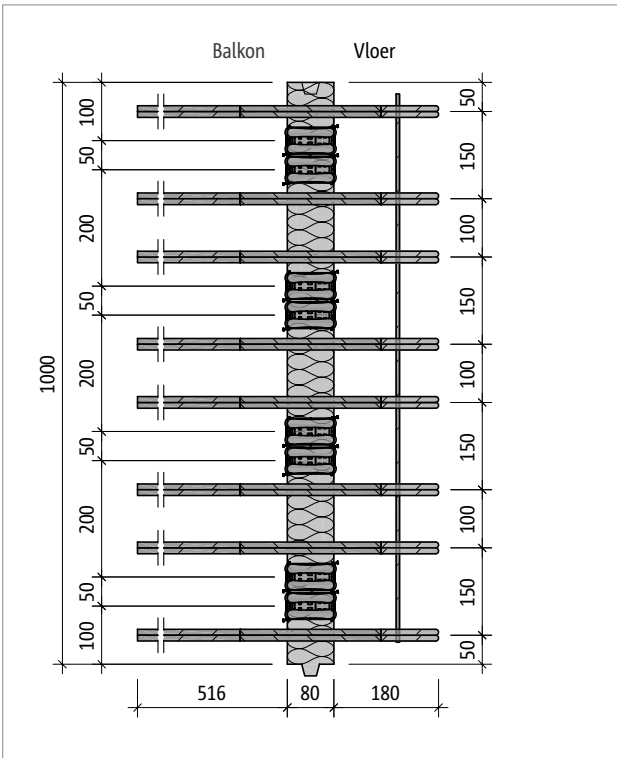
Schöck Isokorf® T type Q-E-VV5: Zijaanzicht
